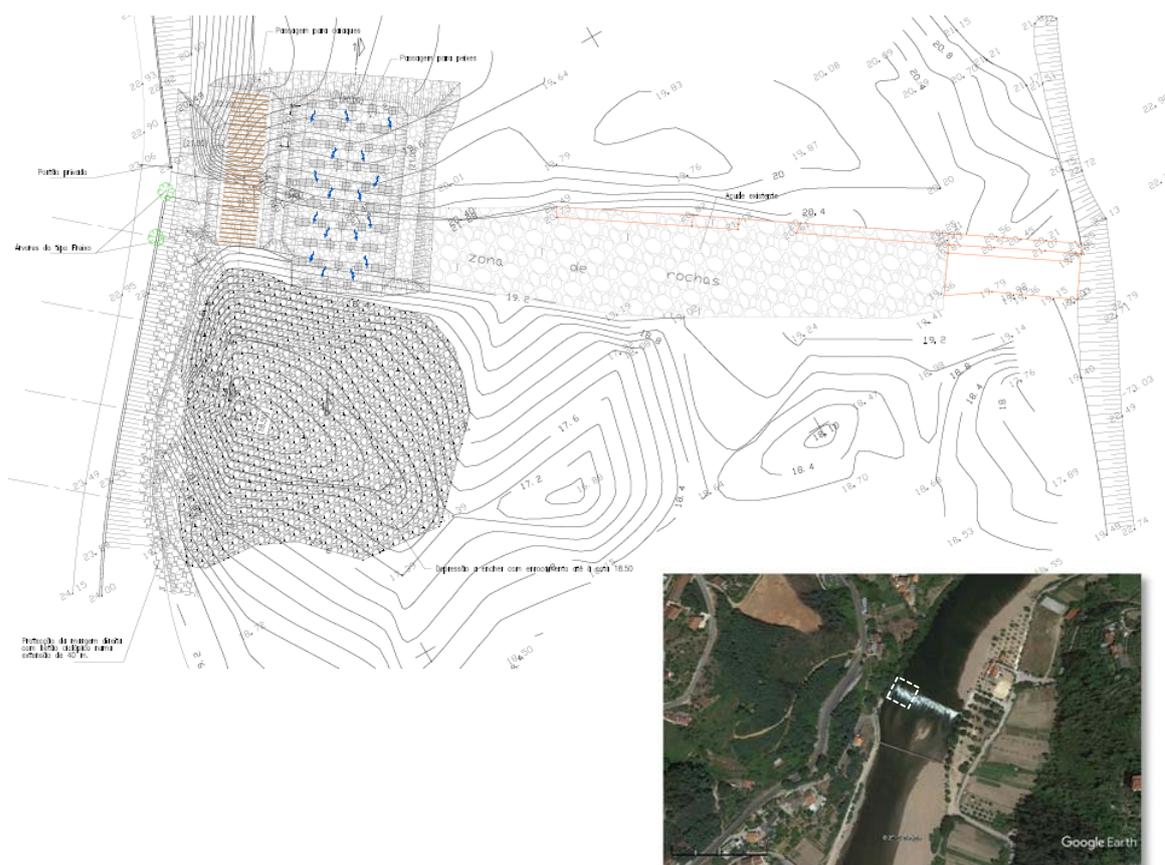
Rampa para peixes do Açude de Palheiros, vista em planta. Vista aérea com o local da intervenção assinalado.
